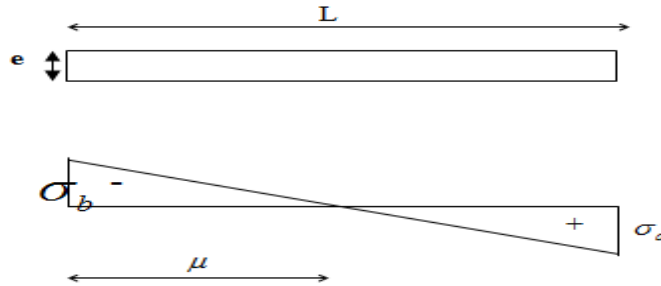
Schéma statique d'une section partiellement comprimée.
